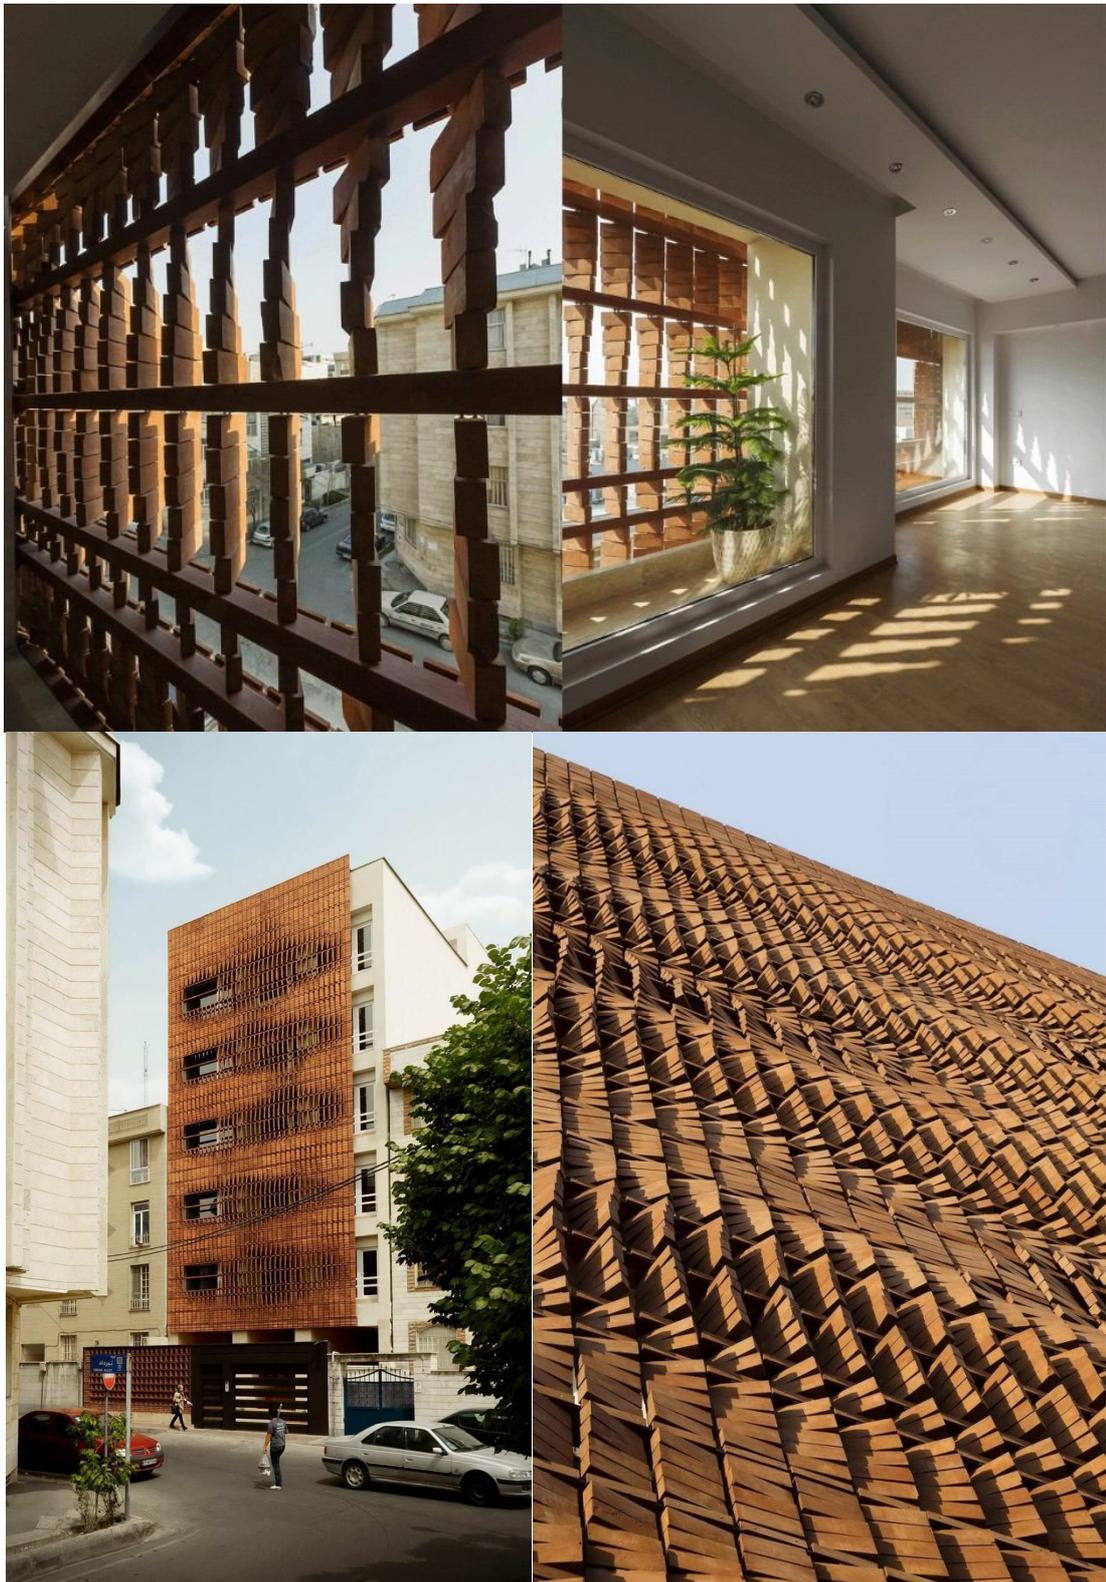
Кирпичный фасад многоэтажного здания в Тегеране, Иран (Архитекторы: Admun Design & Construction Studio, Shobeir Mousavi, Amir Reza Fazel, 2015 г.)
